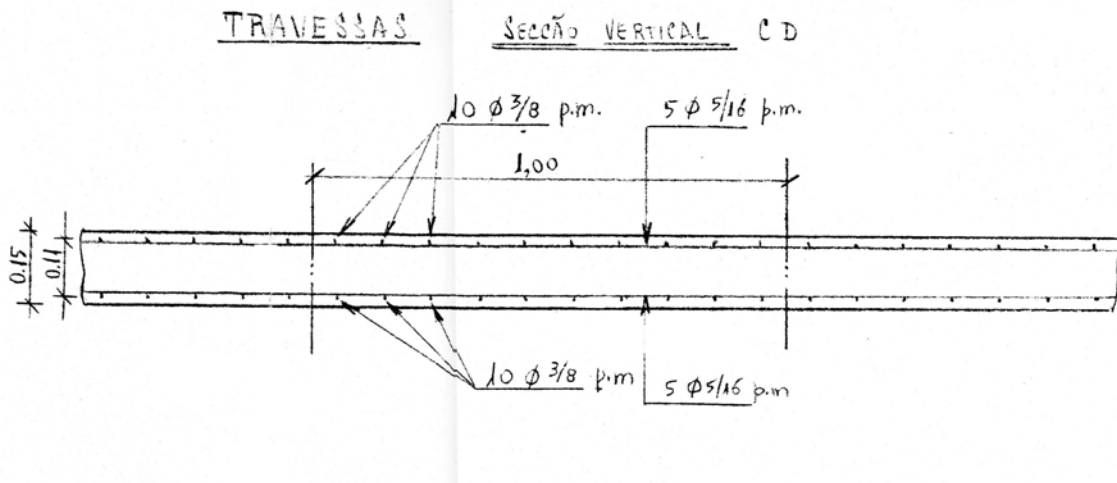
Viaduto das Fragas Más – estrutura de betão armado – travessas (fonte: REFER)
